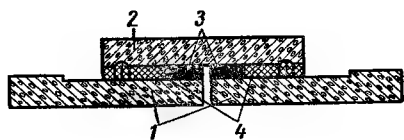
Жесткий стык напряженно-армированных сборных железобетонных труб:
